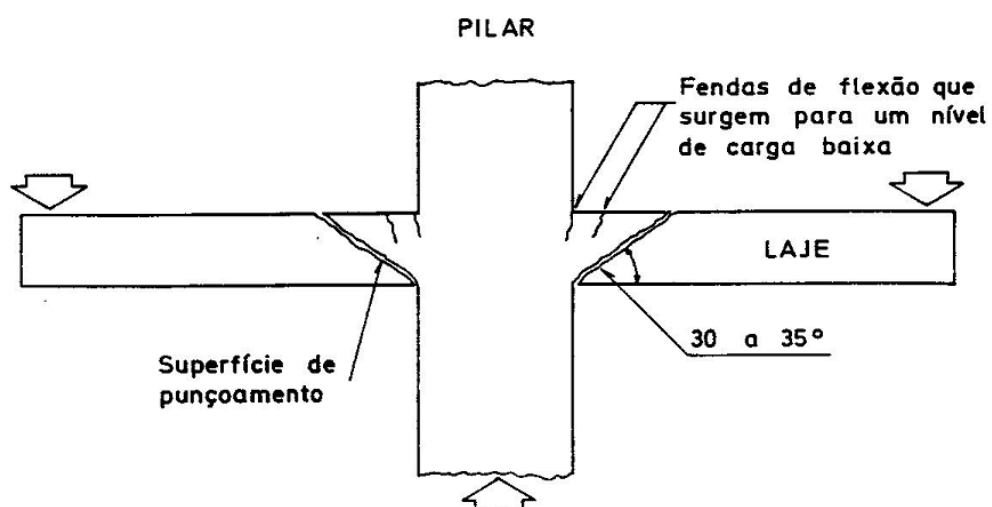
Mecanismo de rotura por punção de um pavimento de lajes [13].
